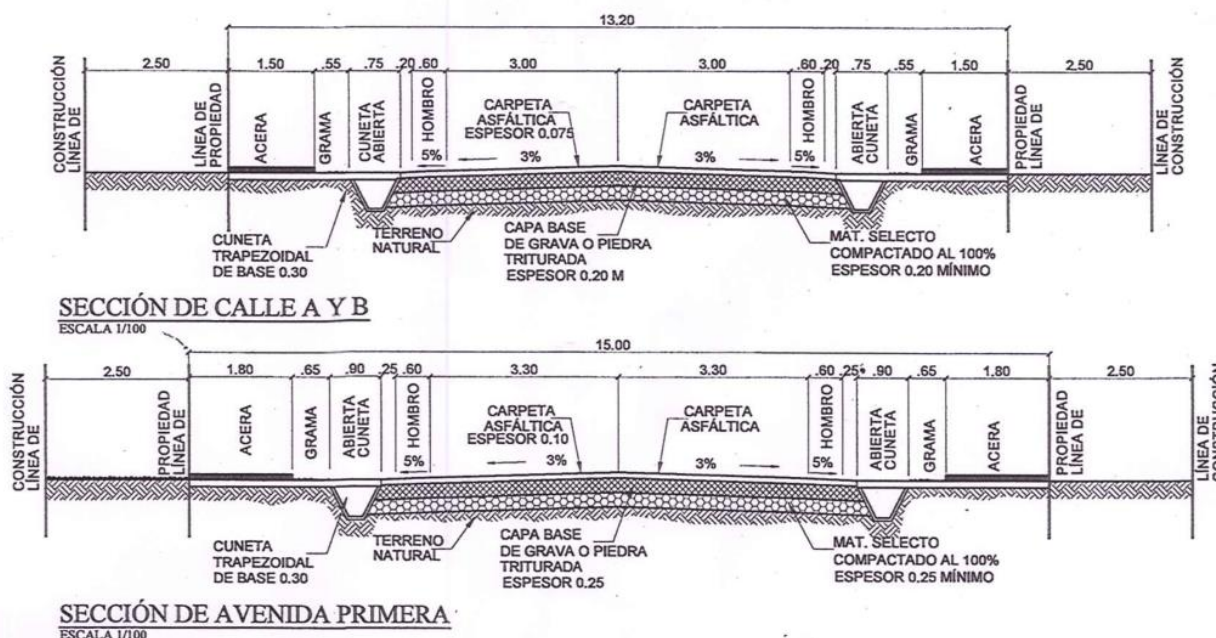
Detalle (sección de calle típica) de Avenida y calles.
